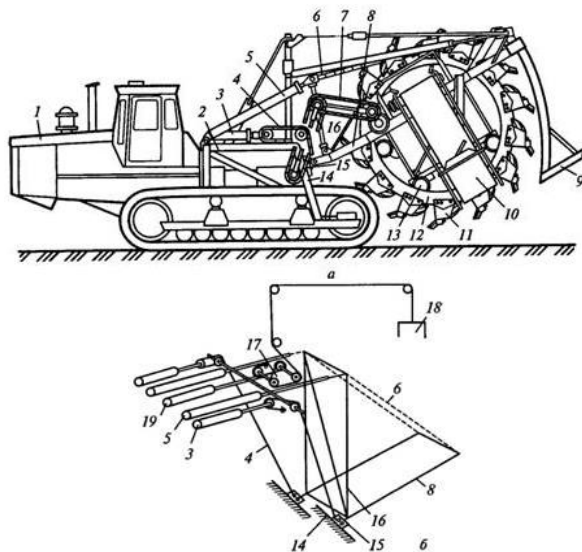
Роторный траншейный экскаватор: а – общий вид в транспортном положении; б - схема механизма подъема ротора:
